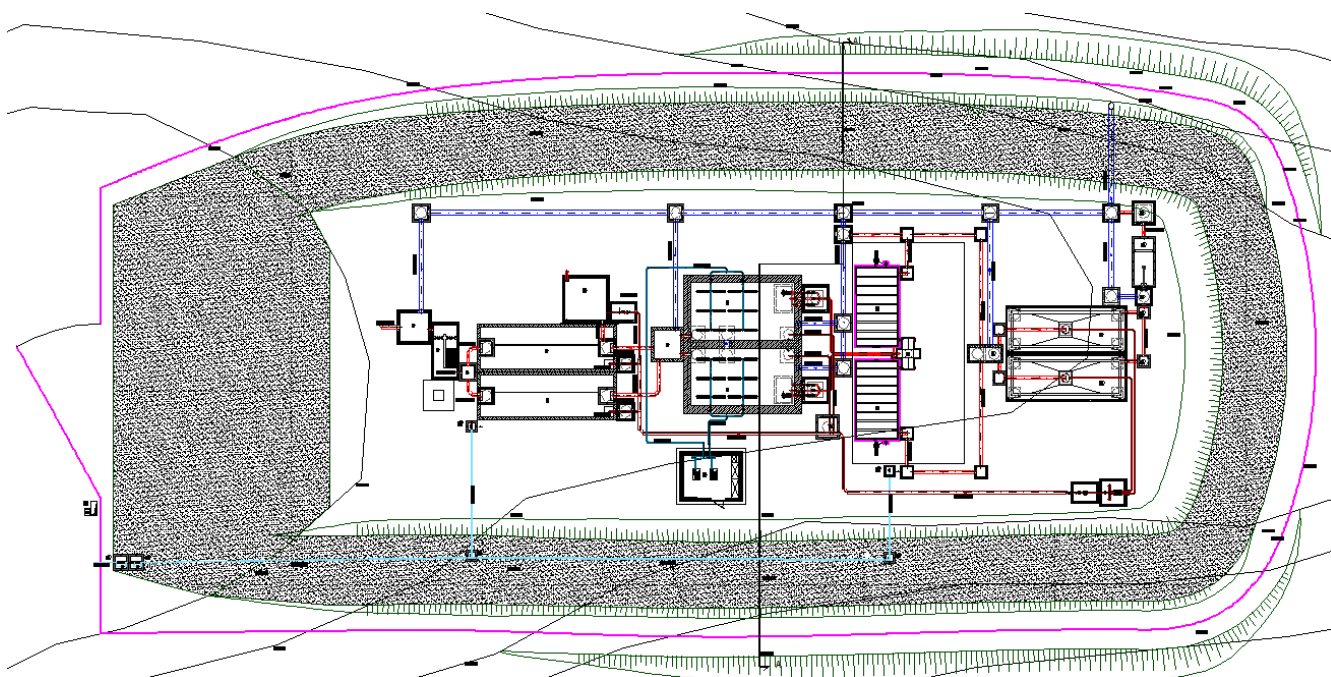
Planimetria di progetto, viabilità sul perimetro esterno
